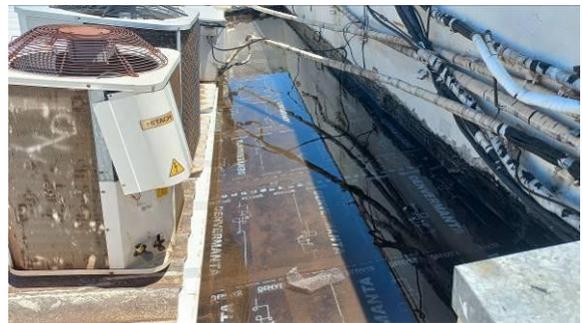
C: Teste de estanqueidade (72h), sendo realizado em laje já impermeabilizada sobre o Cejusc
